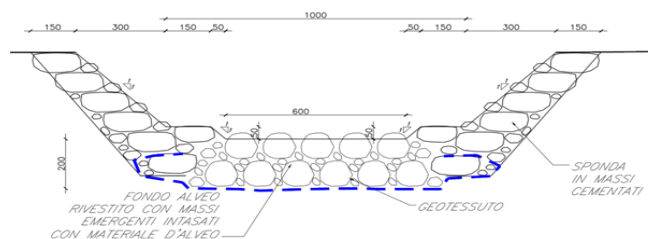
Sezione tipo dell'alveo in corrispondenza dell'attraversamento
